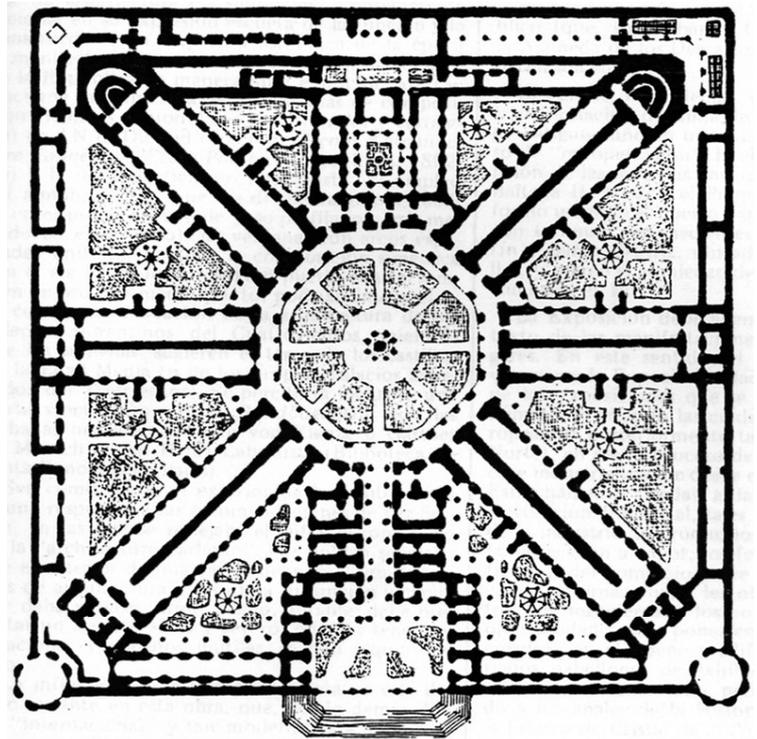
Hospital Dos de Mayo. Lima. Plano primitivo.
